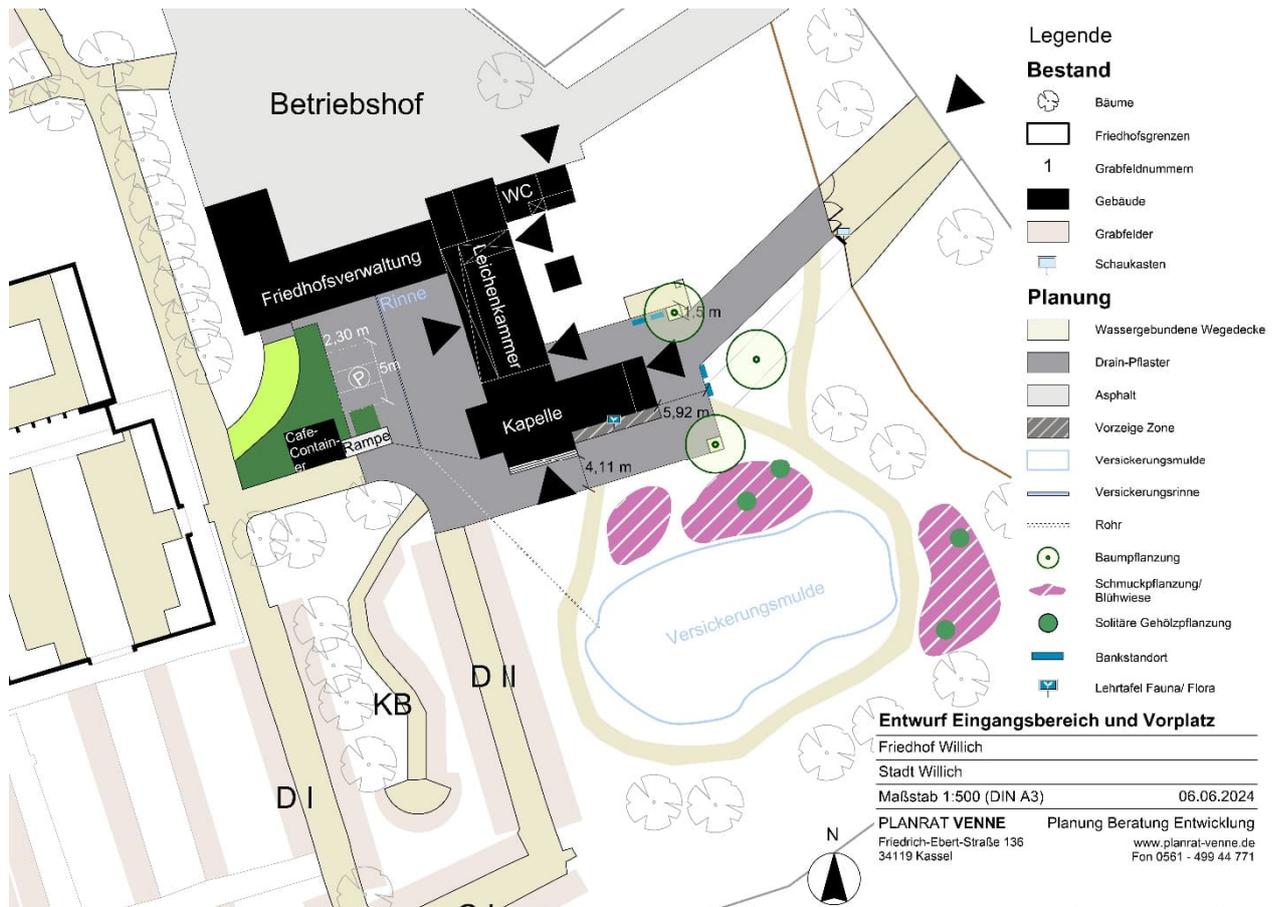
Entwurf Osteingang, Lageplan Friedhof Willich
